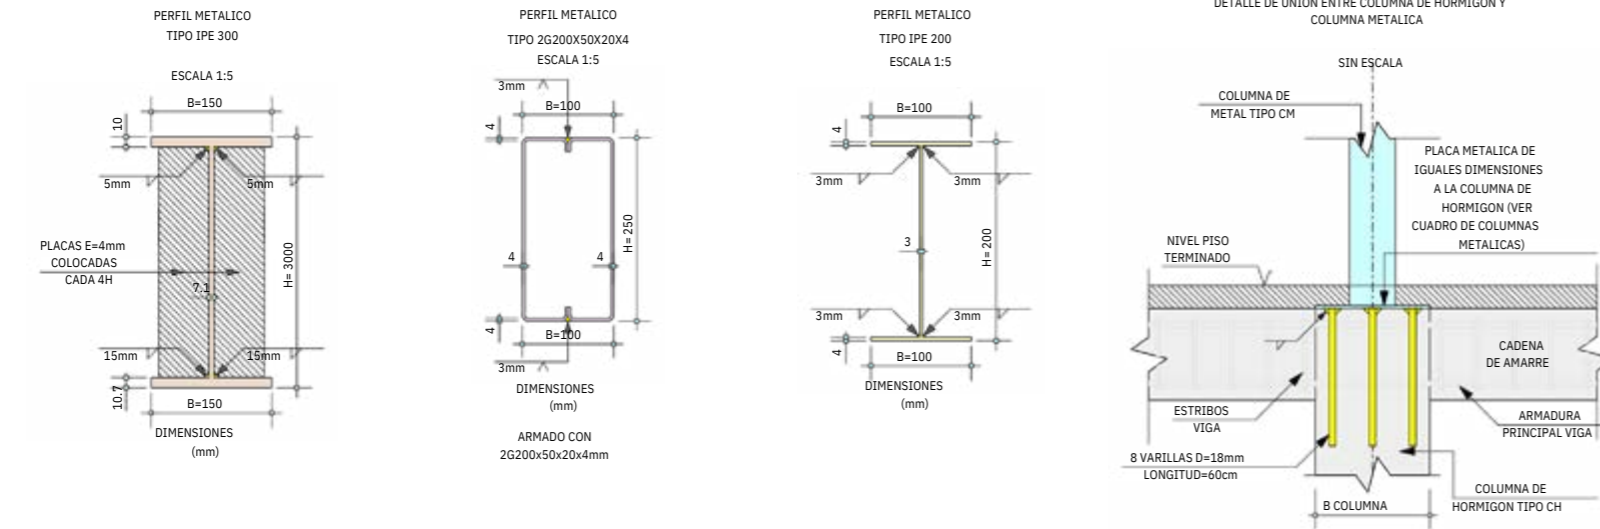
Detalles constructivos del proyecto. Nota. Elaboración propia
